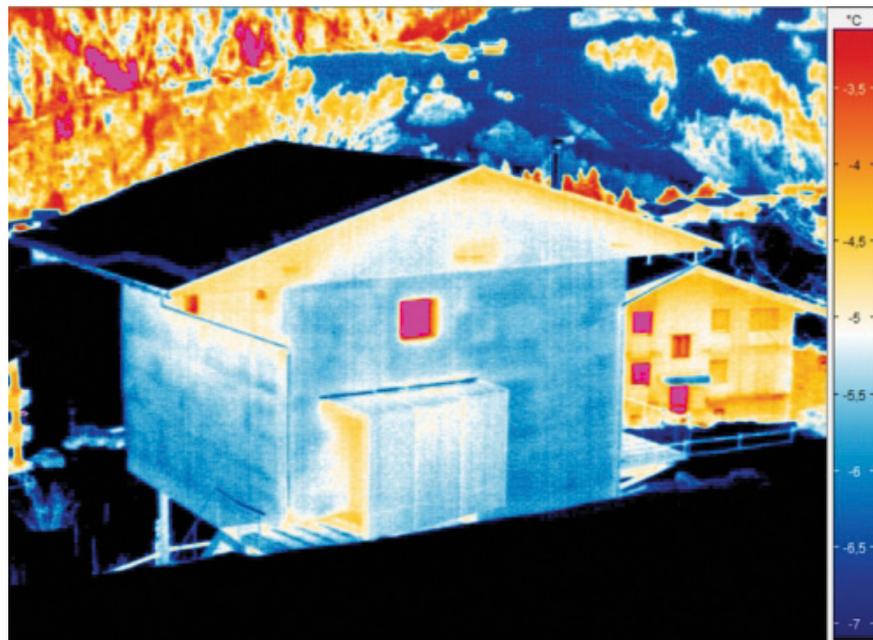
Wärmebildvergleich eines Strohhaus mit einem konventionelles Haus
